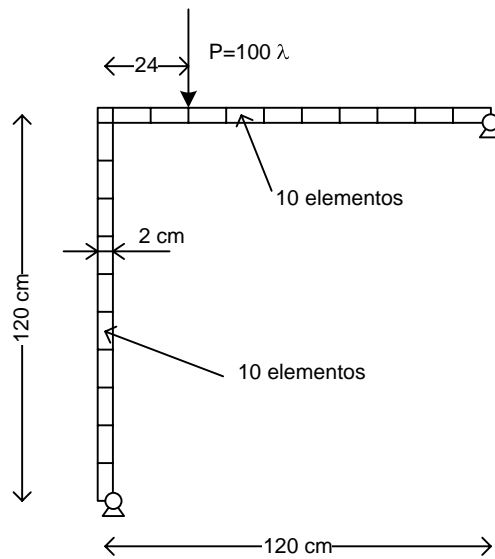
Pórtico biarticulado. Modelo con elementos planos de 4 nudos.
